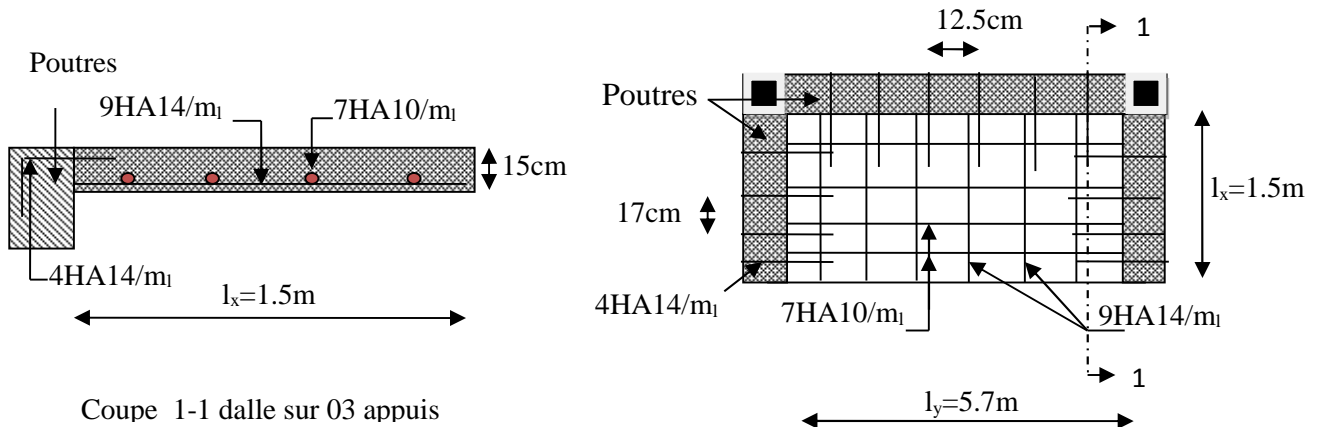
Schéma de ferrailage de dalle sur 3 appuis
